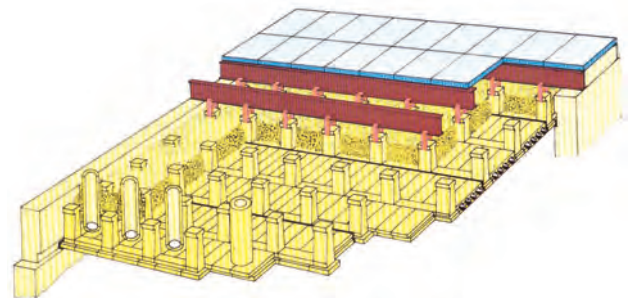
Schema einer BURTON-Hängedecke aus trocken-gepreßten Elementen
